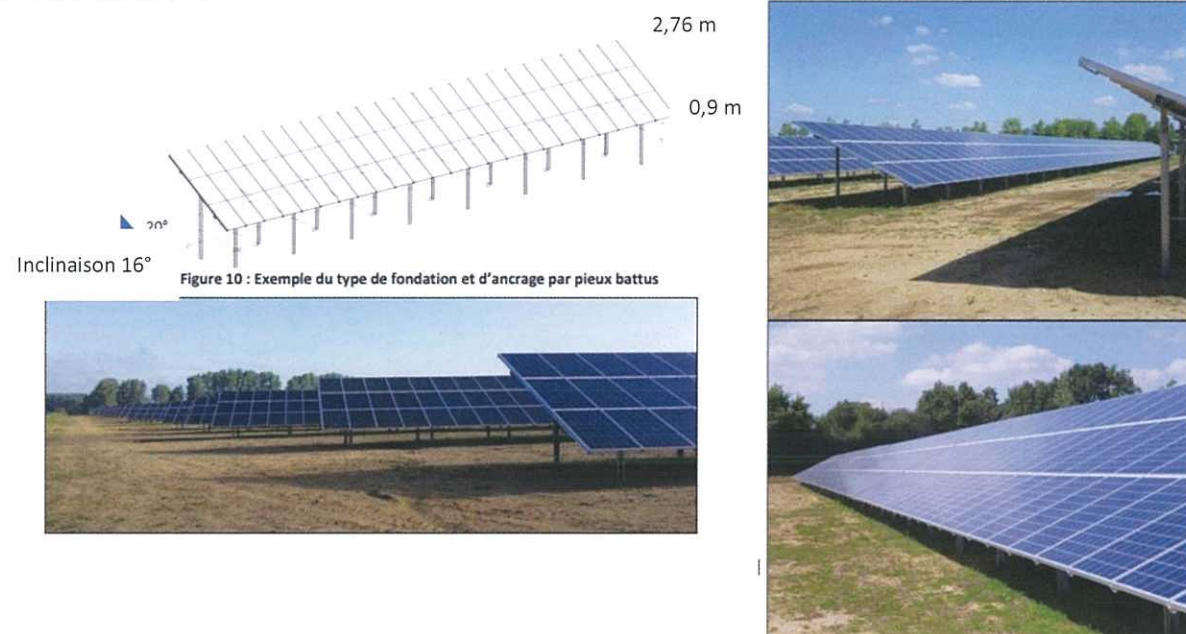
Exemple du type de fondation et d'ancrage par pieux battus
